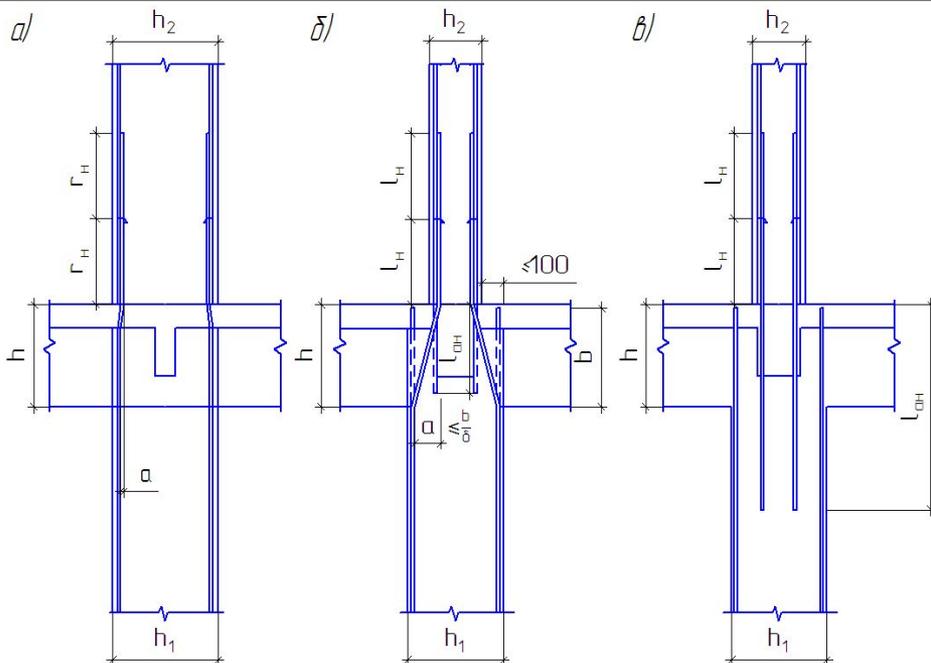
Схема устройства стыков продольных стержней монолитных колонн многоэтажных зданий :
